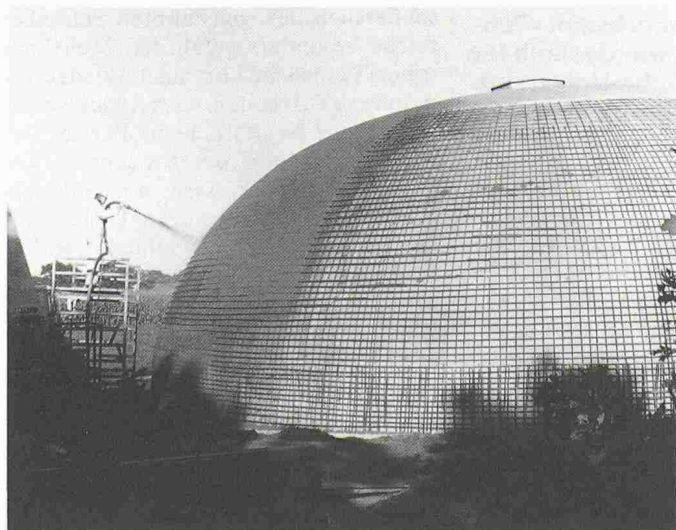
Silo mit 6 m hoher Kuppel (15 m Ø) aus Stahlfaserspritzbeton auf aufblasbarer Schalung erstellt
